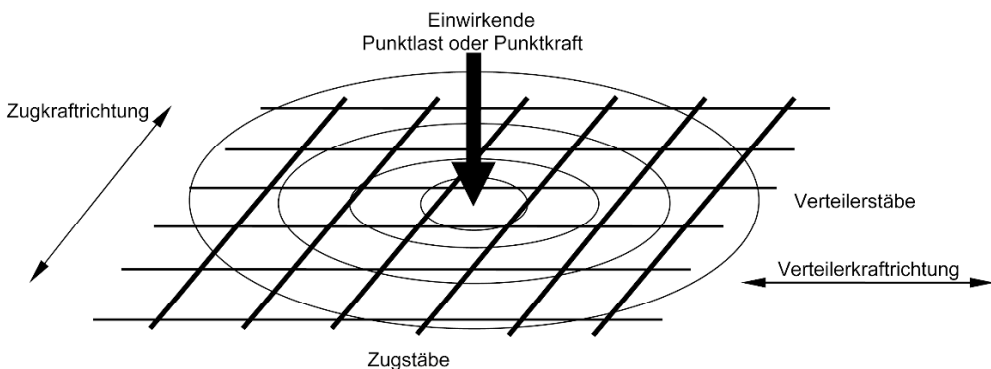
Wirkprinzip einer Lastenverteilung in einem ebenen Geflecht gerader kreuzweise liegender Betonstahlstäbe.
